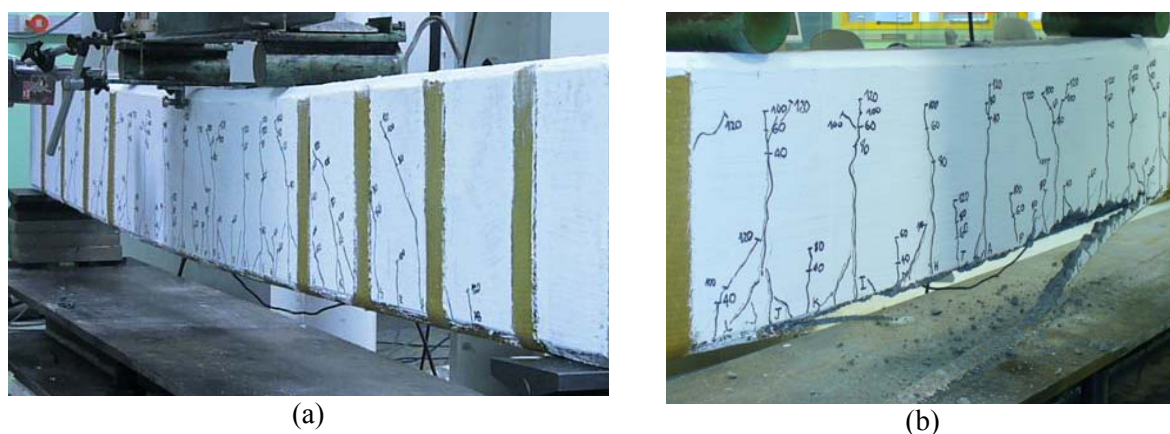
Viga VFA_01: (a) Viga momentos antes da ruptura; (b) Detalhe da ruptura do reforço no vão central da viga.
